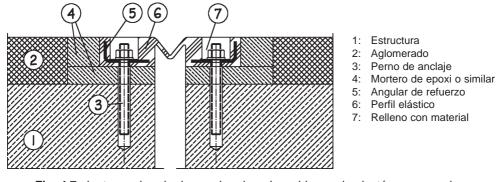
Junta con banda de caucho plegadas y bloque de elastómero armado.
